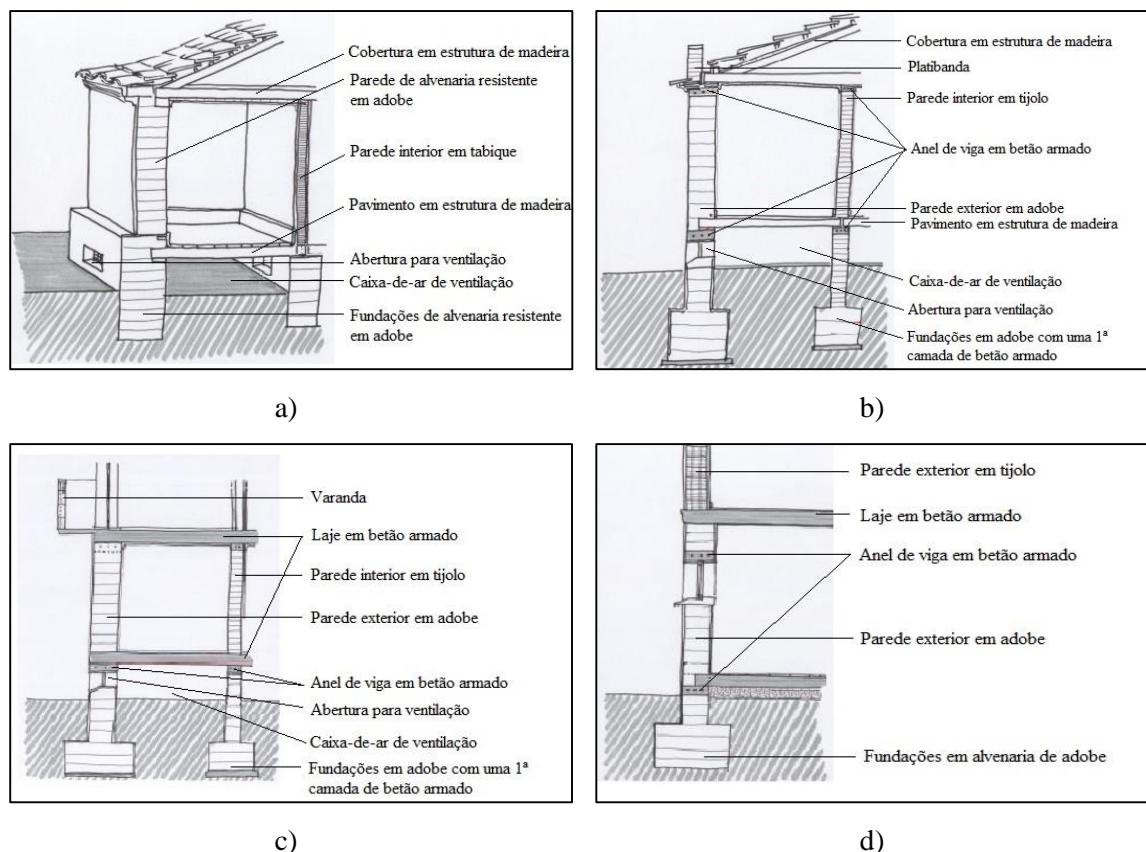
Evolução do sistema construtivo de adobe em Ílhavo; a) Sistema tradicional; b) Sistema com introdução de anéis de viga em betão armado; c) Sistema com introdução de lajes em betão armado; d) Sistema híbrido. Adaptado de (Tavares *et al.*, 2012b)
